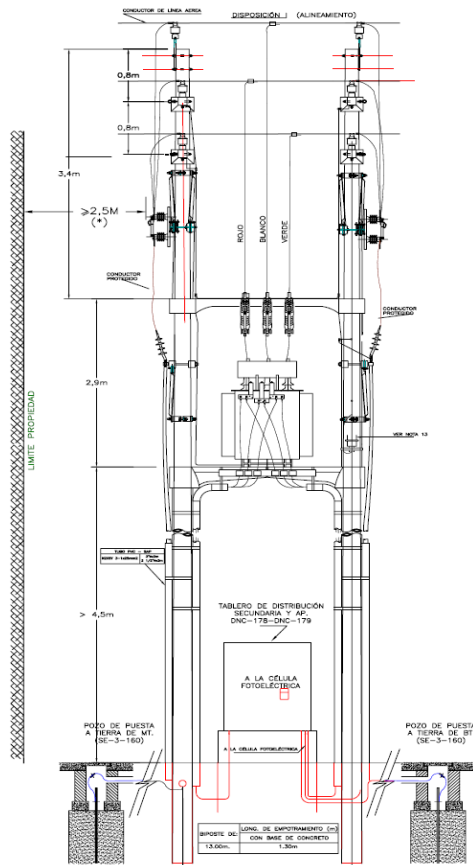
Montaje de los elementos estructurales que componen las SAB
